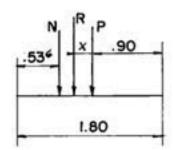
CARGAS SOBRE LAZAPATA SISMO TRANSVERSAL
